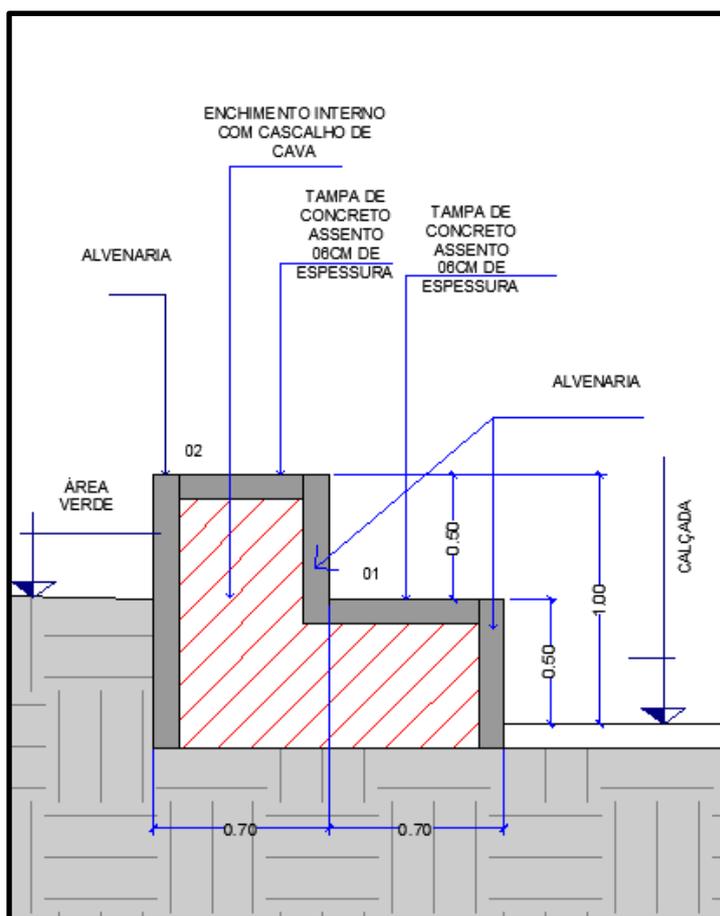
CORTE ESQUEMÁTICO DA ARQUIBANCADA RETIRADO DO PROJETO.
